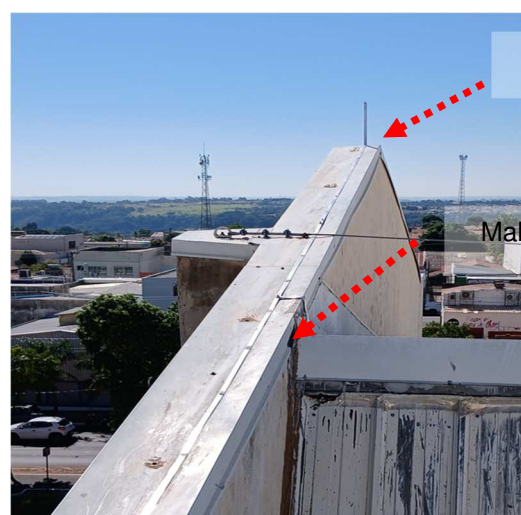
e 127: Malha captora construída em perfil de alumínio seção #70mm².
